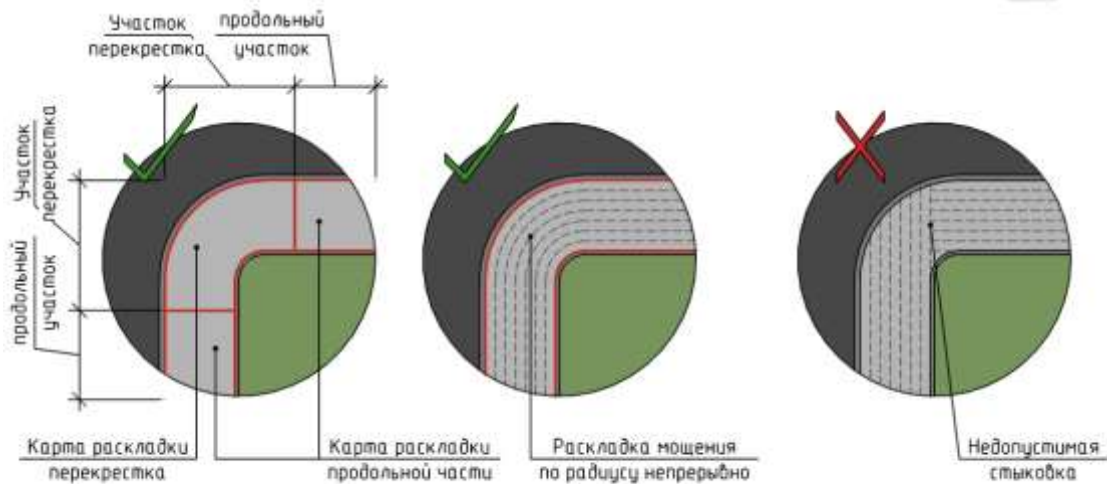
Принципиальная схема организации карт раскладки на перекресте.
